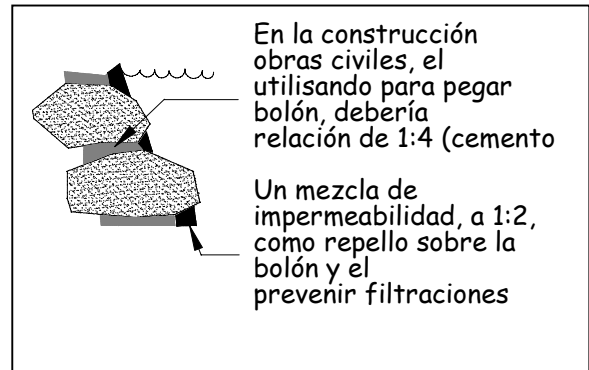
Técnica de mampostería para obras civiles de pico centrales hidros
